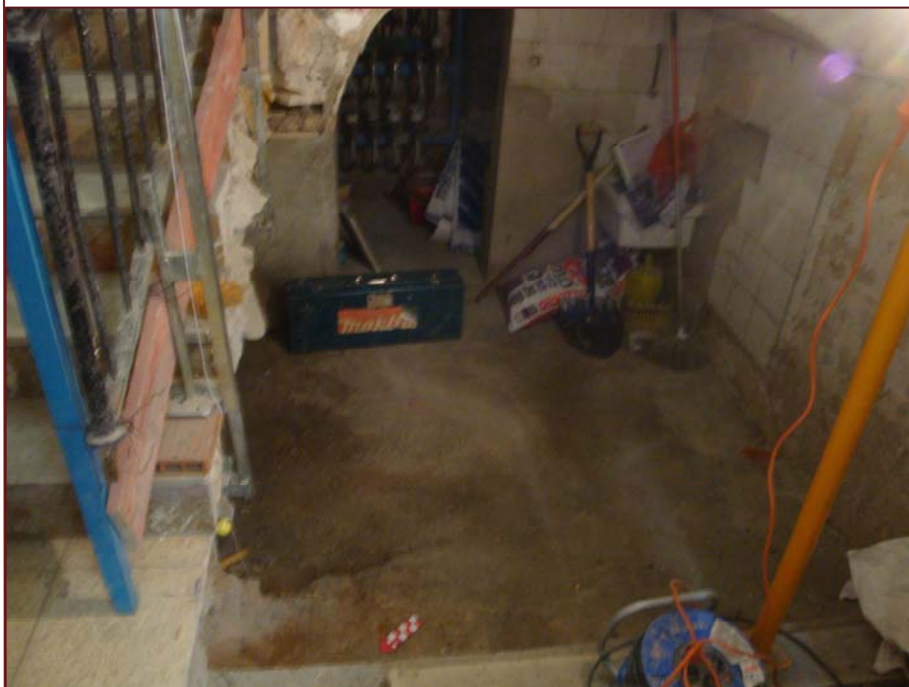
Vista general del paviment UE 01, i imatge inicial d'excavació.
